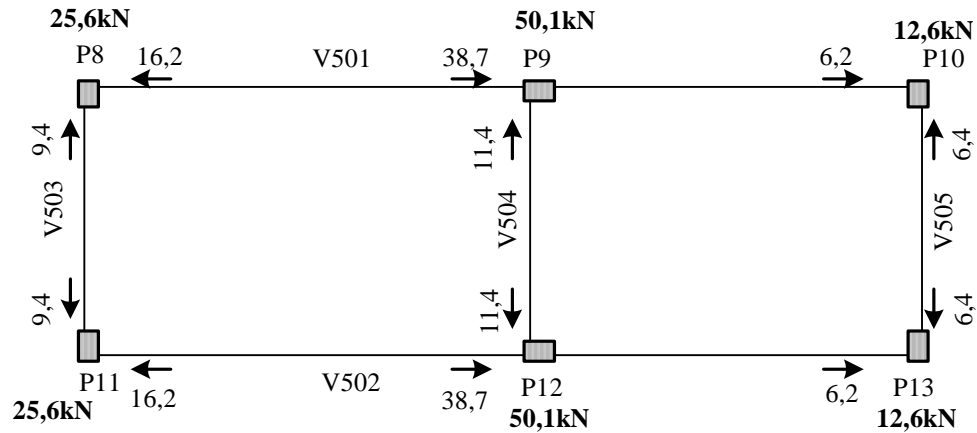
Cargas transmitidas aos pilares pelas vigas do teto da casa de máquinas (em kN)
